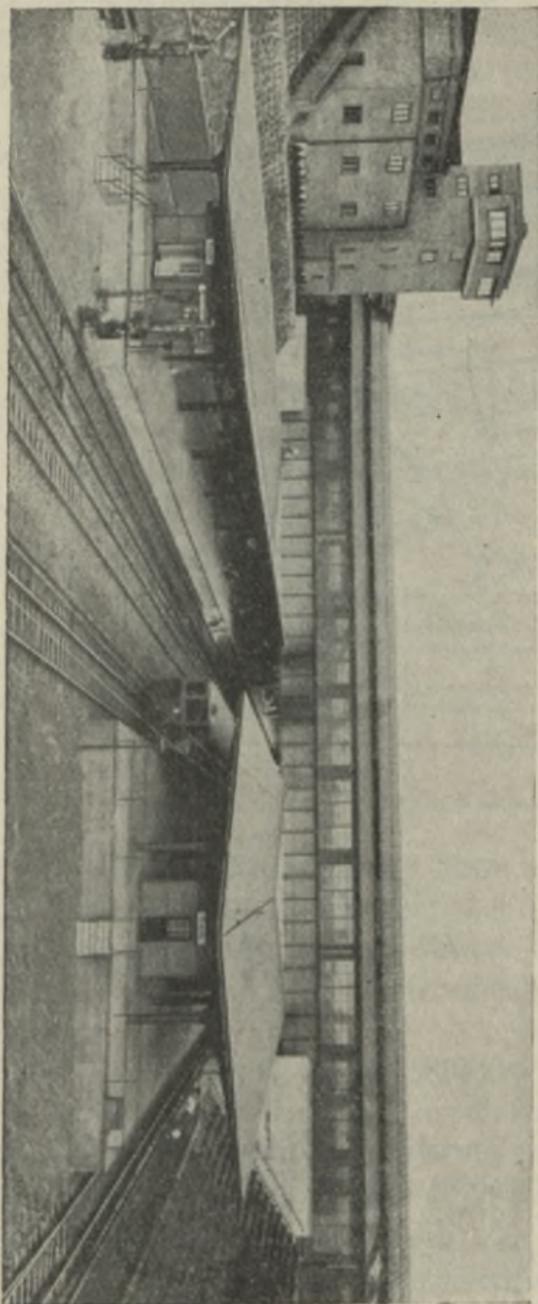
Empfangsgebäude Bahnhof „Ausstellung“, Berlin. (Lichtbild.)
